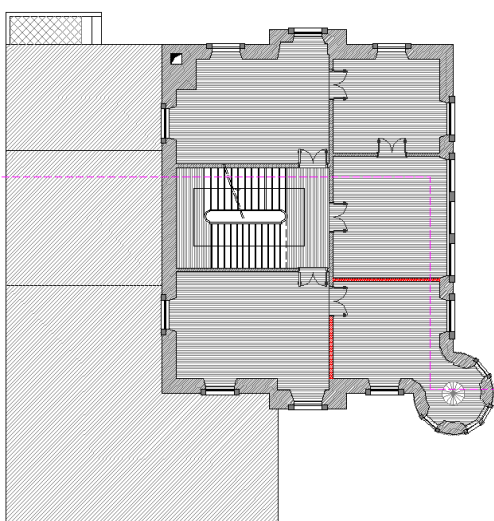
Localização em planta da fissuração e fendilhação nas paredes divisórias do 1º piso.
